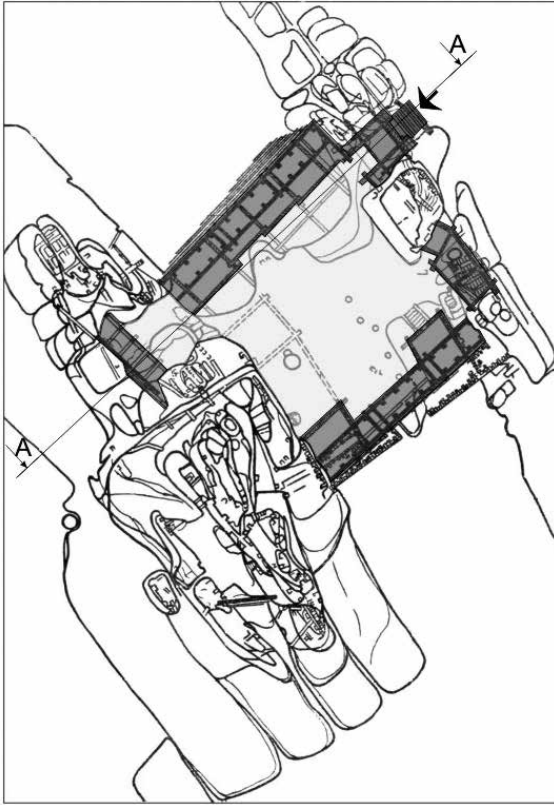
План дерев'яної забудови першого будівельного періоду. Реконструкція автора.
